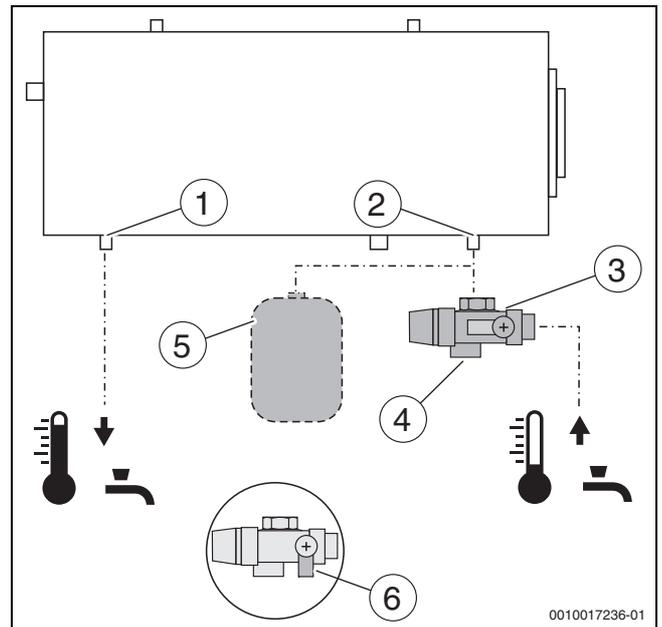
Raccordement des conduites d'eau chaude sanitaire
